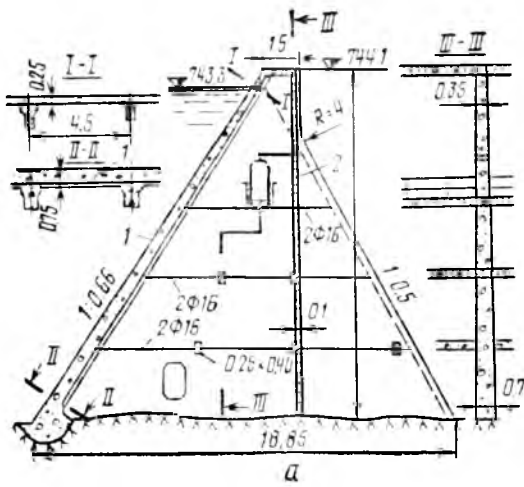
Плотины с плоскими напорными перекрытиями:
